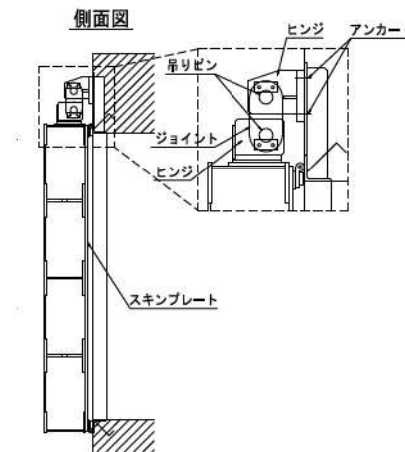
屋外排水路逆流防止設備構造例（断面図）
